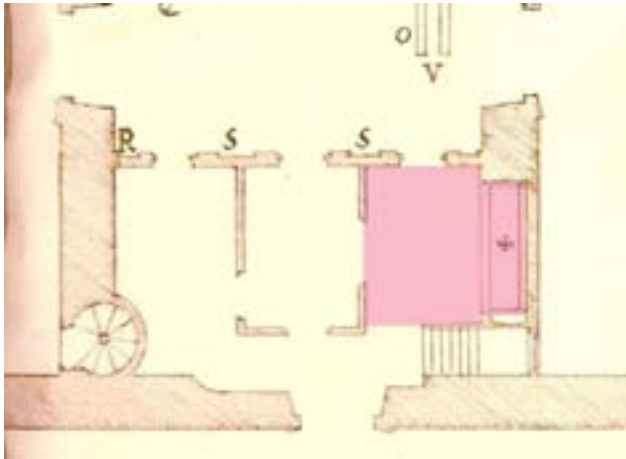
Etiquetas generales 1651 Detalle de la Planta de la Capilla con indicación del oratorio
